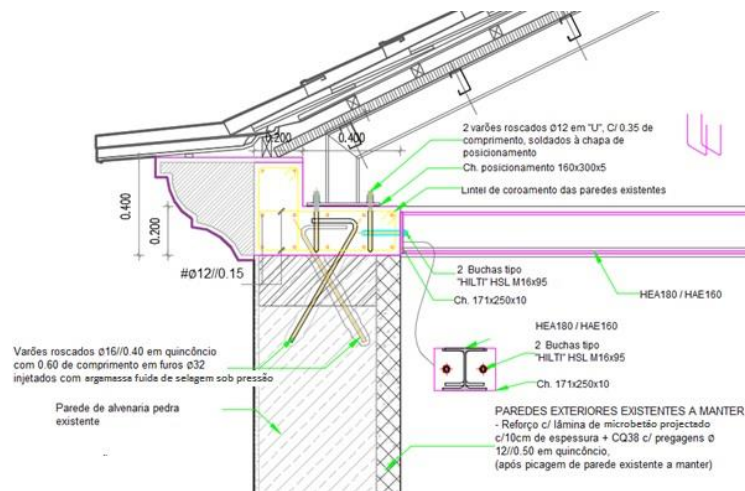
Pormenor de ligação das vigas de cobertura ao lintel de coroamento
